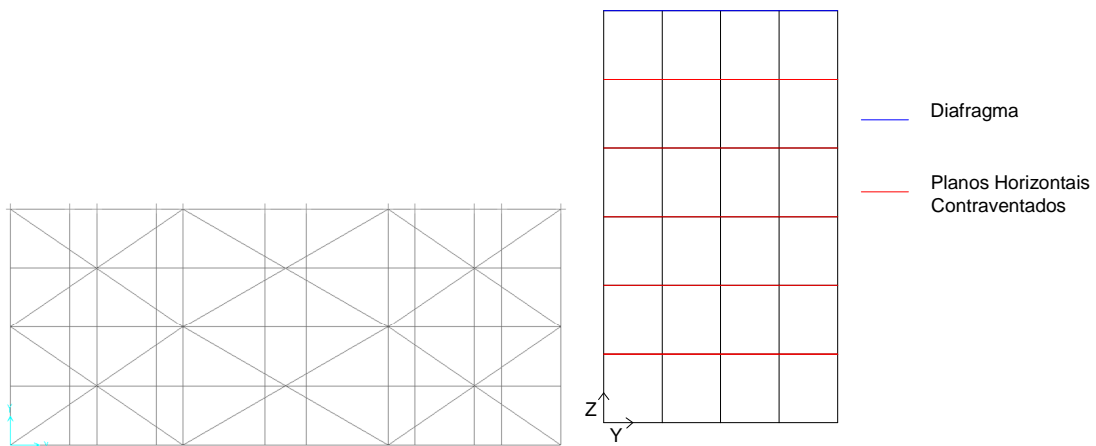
Configuração dos Planos de Contraventamento Horizontal Com Elementos de Contraventamento Grandes
